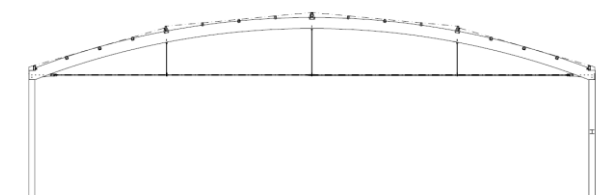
Plano de sección de estructura tipo arco atirantado
